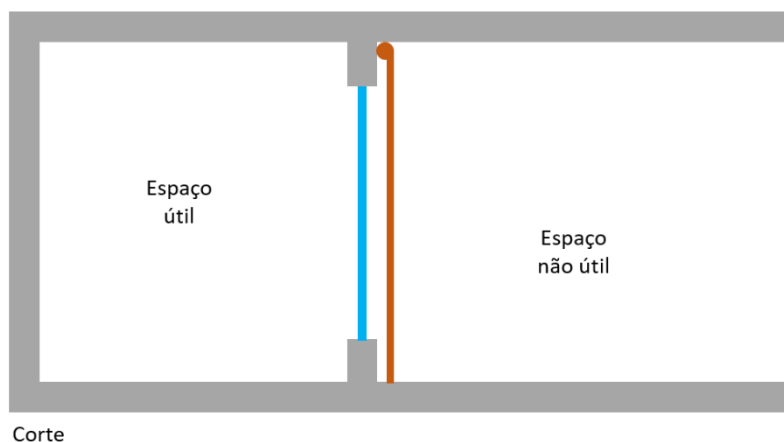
Área efetiva coletora de um vão envidraçado (estação de arrefecimento).
